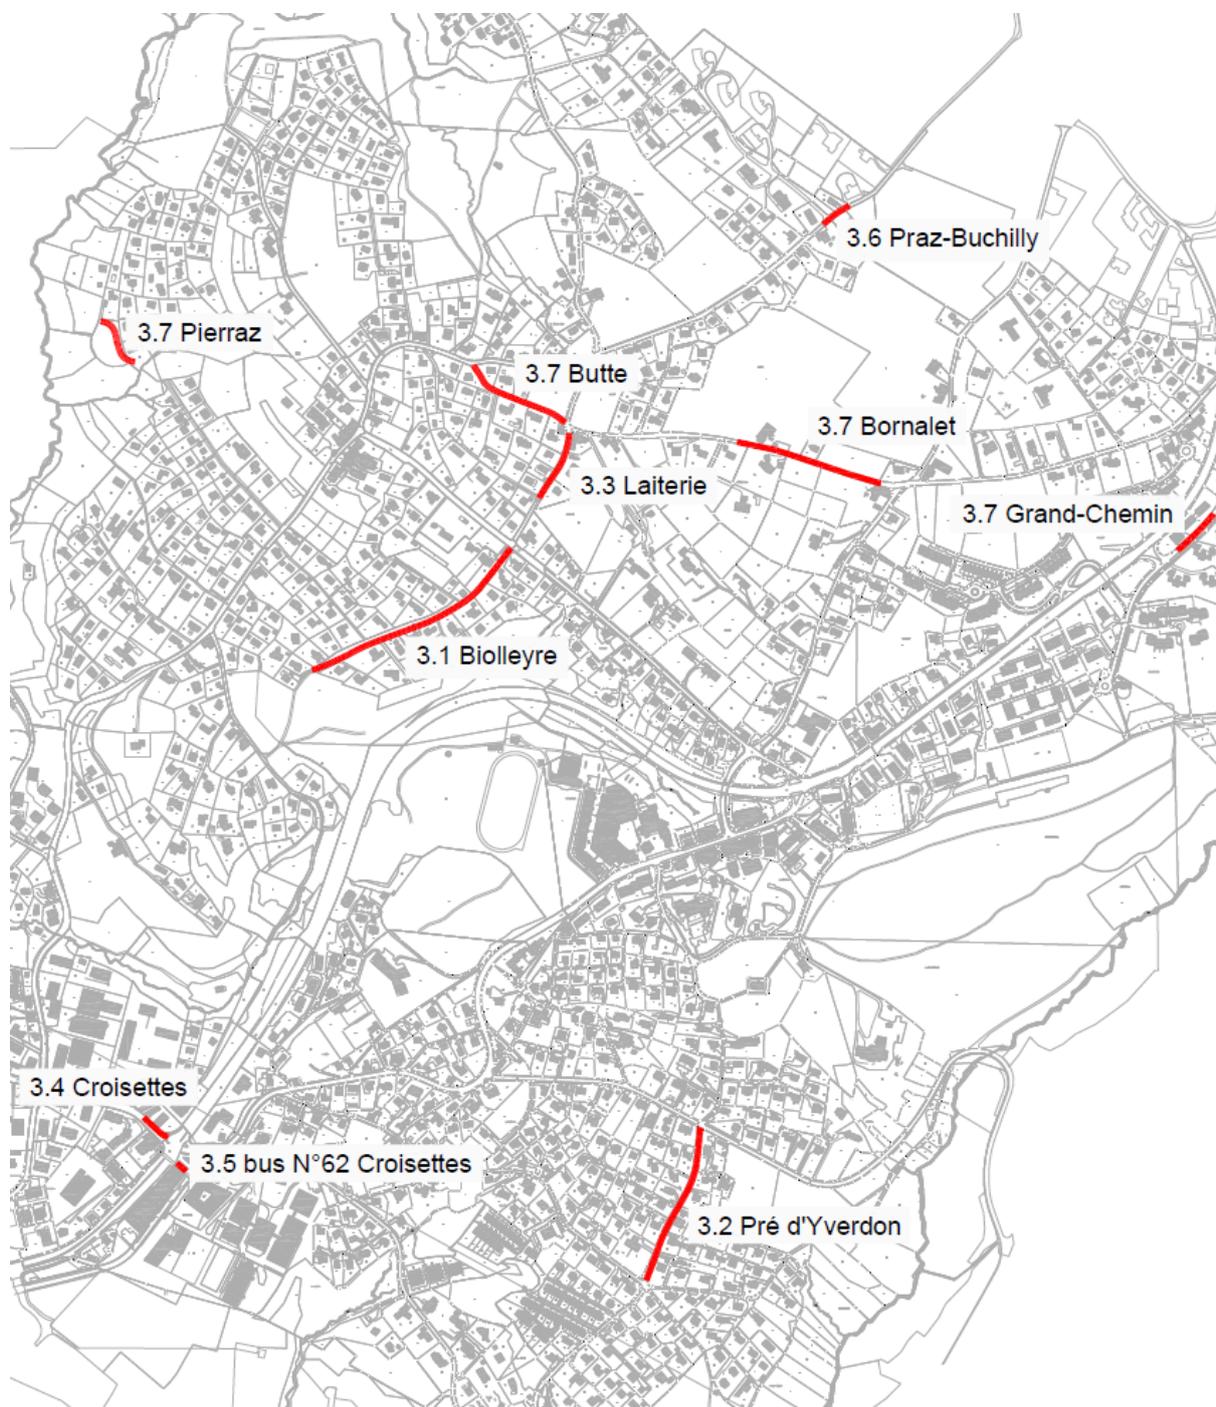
Plan de situation avec l'ensemble des travaux projetés
